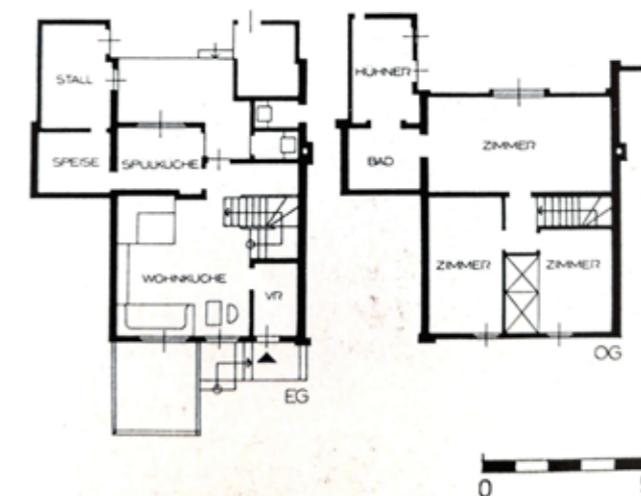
Heuberg-Siedlung, Hausgrundrisse
